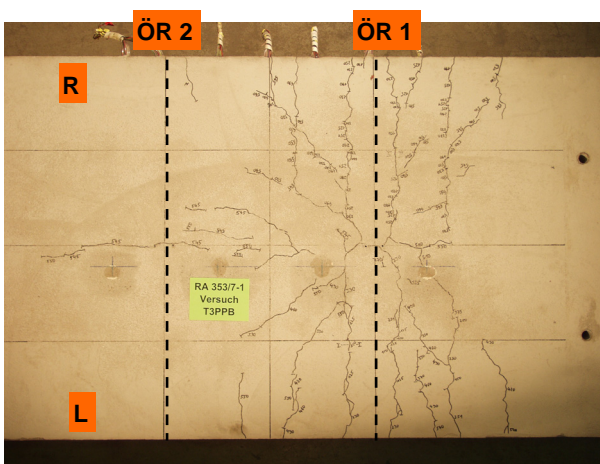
Rissbild auf der Betongurtoberseite
